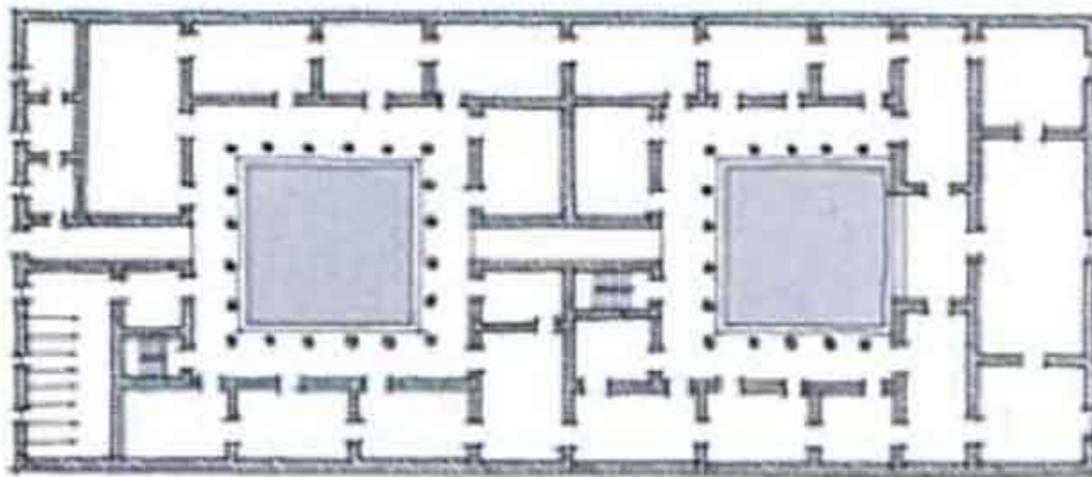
Planta da Casa Helénica segundo Vitruvius.
